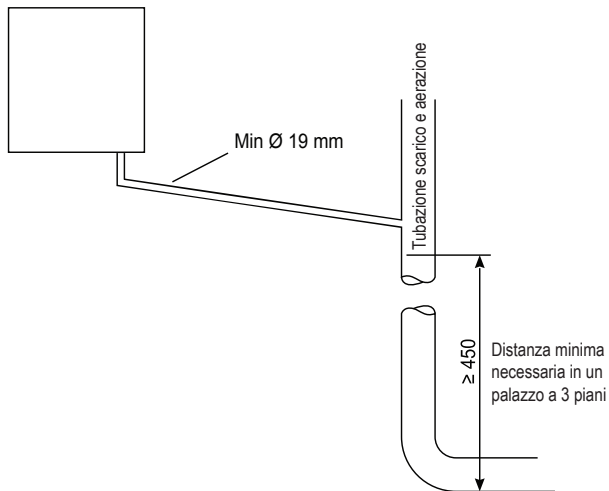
Collegamento del tubo di drenaggio dell'acqua di condensa al tubo di drenaggio interno e di ventilazione
